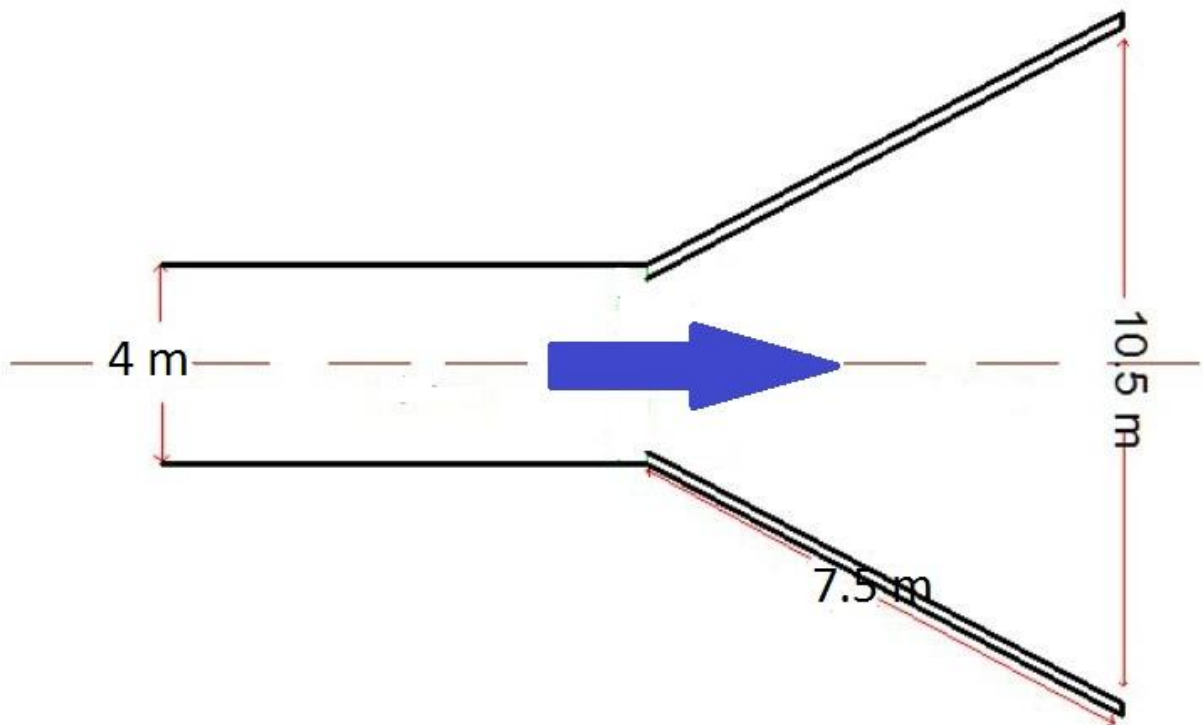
coupe type de l'ouvrage de sortie l'oued Malleh avec ses dimensions
